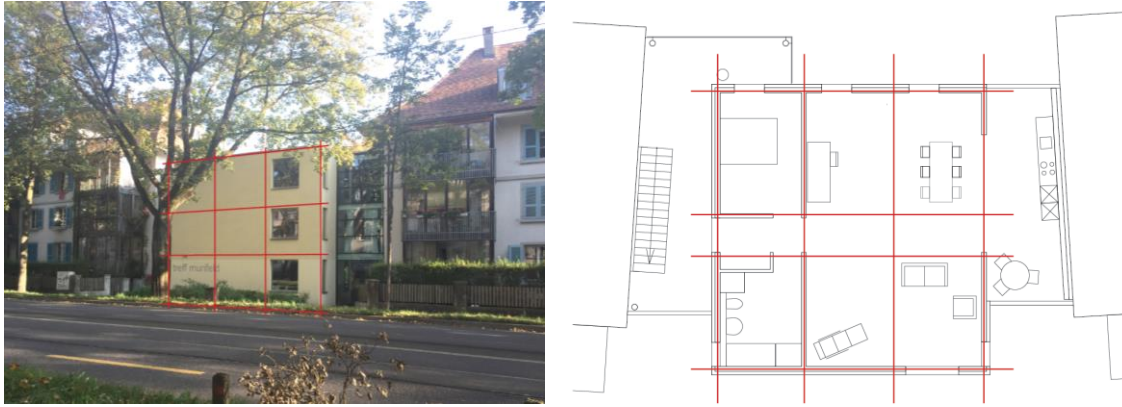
Treff Murifeld, Berne, photo et plan / Bauart Architekten und Planer AG
